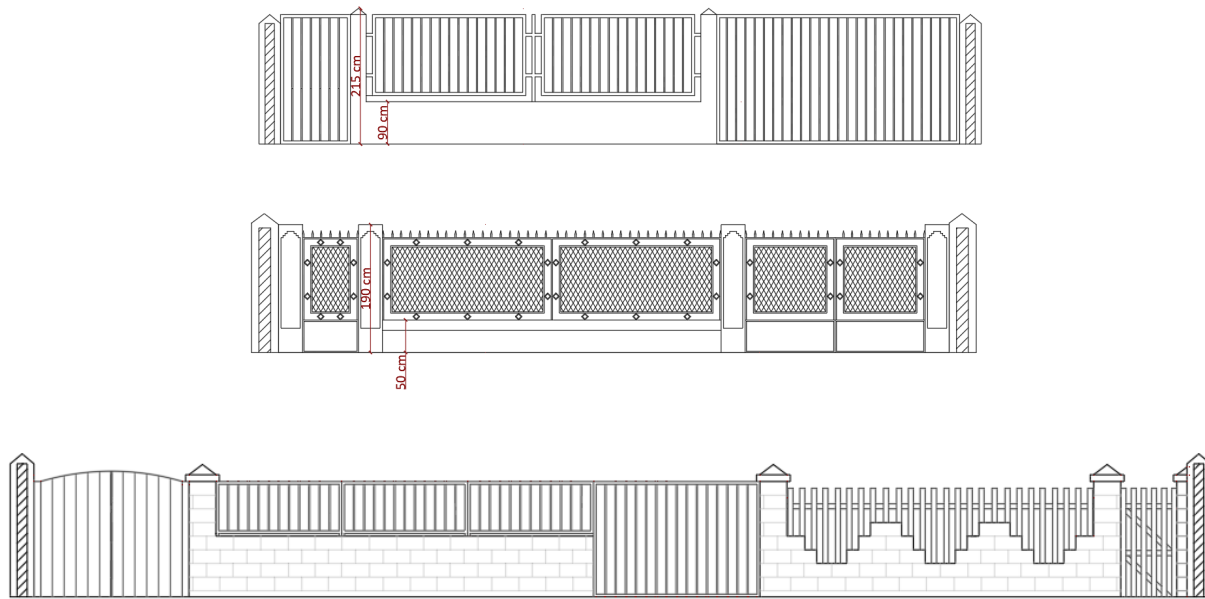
Elevaciones de cierros en el barrio. Fuente: Elaboración propia.
